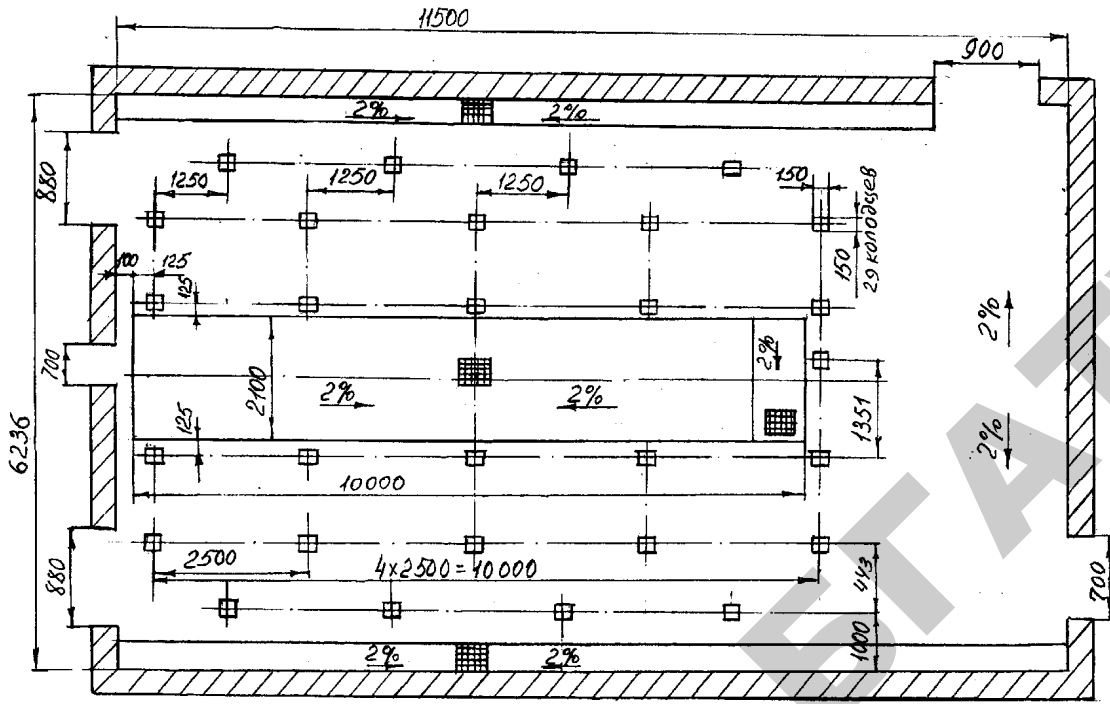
Планировка доильного зала с доильной установкой УДА-8Т
